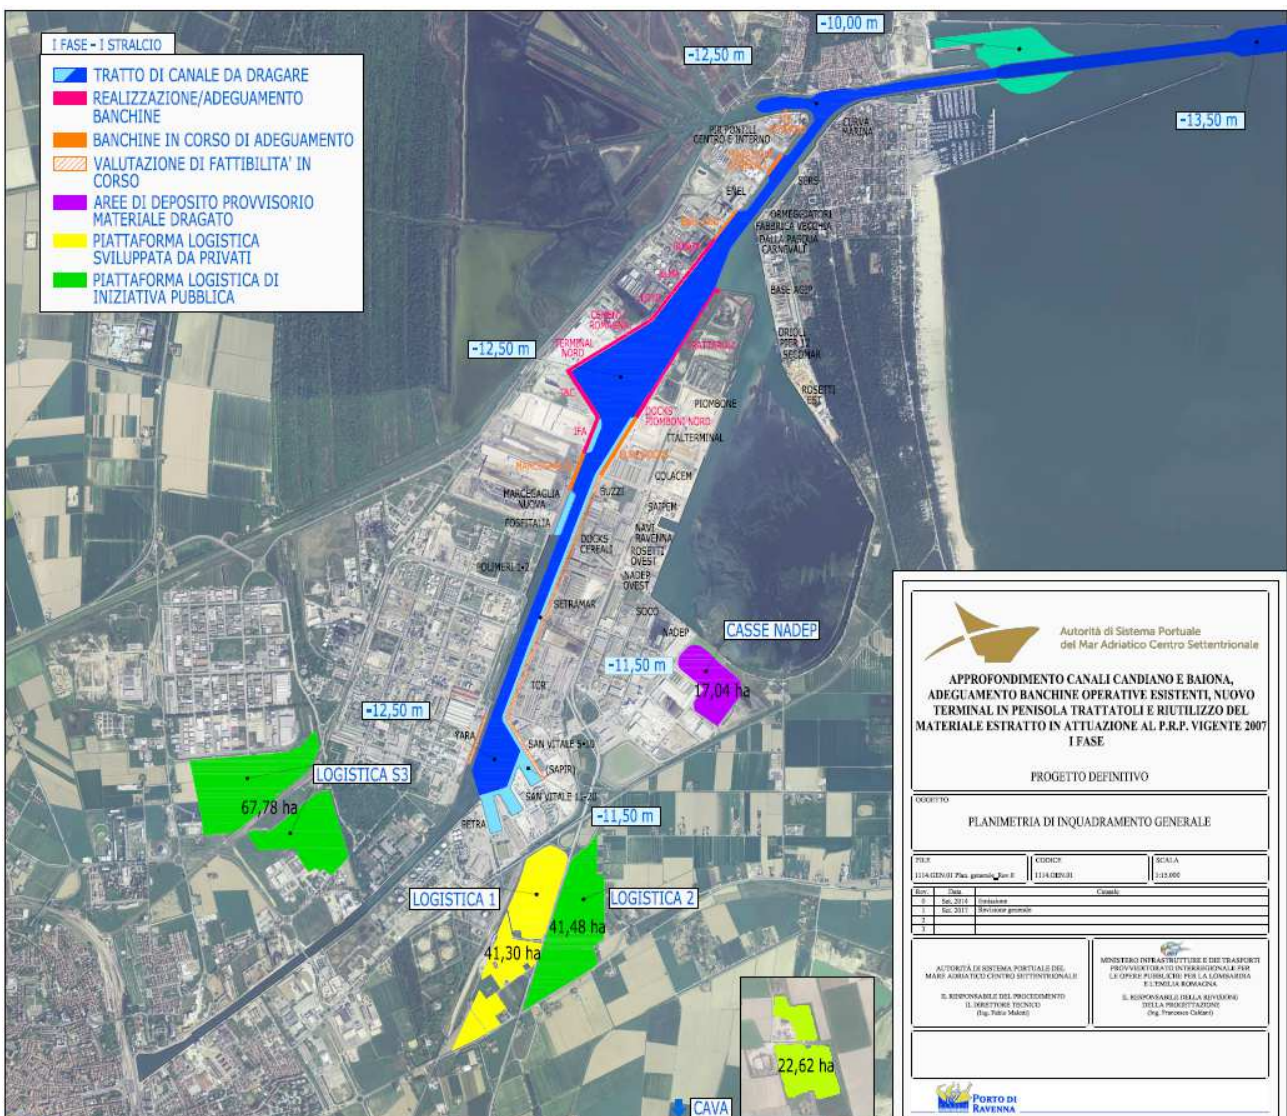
Planimetria del porto con indicazione dell’escavo del canale portuale di FASE I
